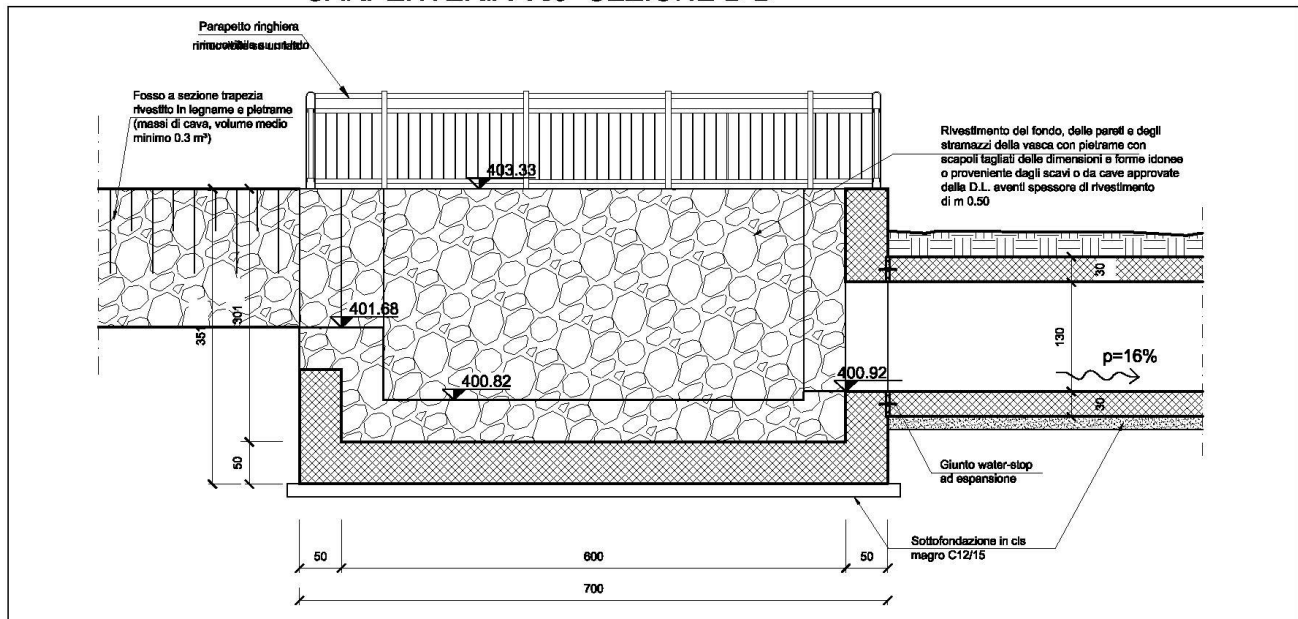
Sistema compluvio sud – Vasca Vs0 – sezione B-B
